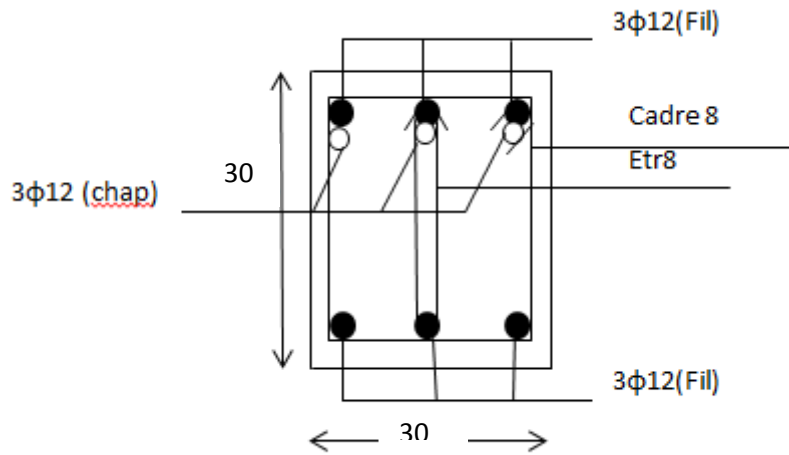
ferrailage des poutres secondaires aux appuis
